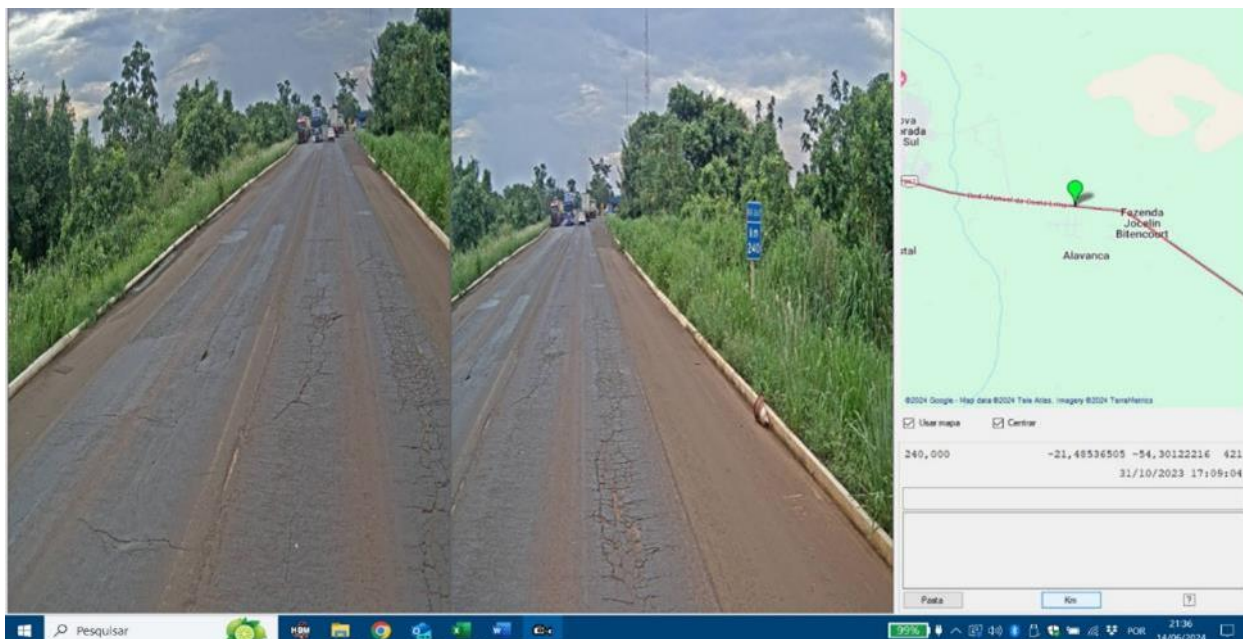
Fotos Gerais do Pavimento - BR-267 - Km 240.
